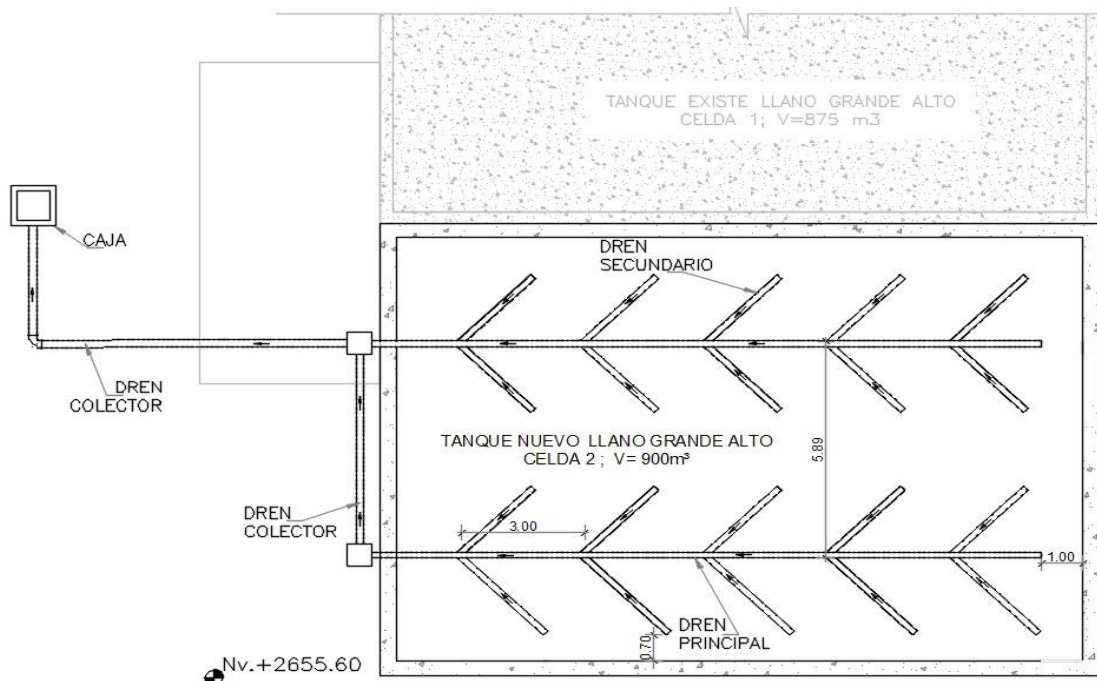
Configuración de Subdrenaje Llano Grande Alto, vista en planta
